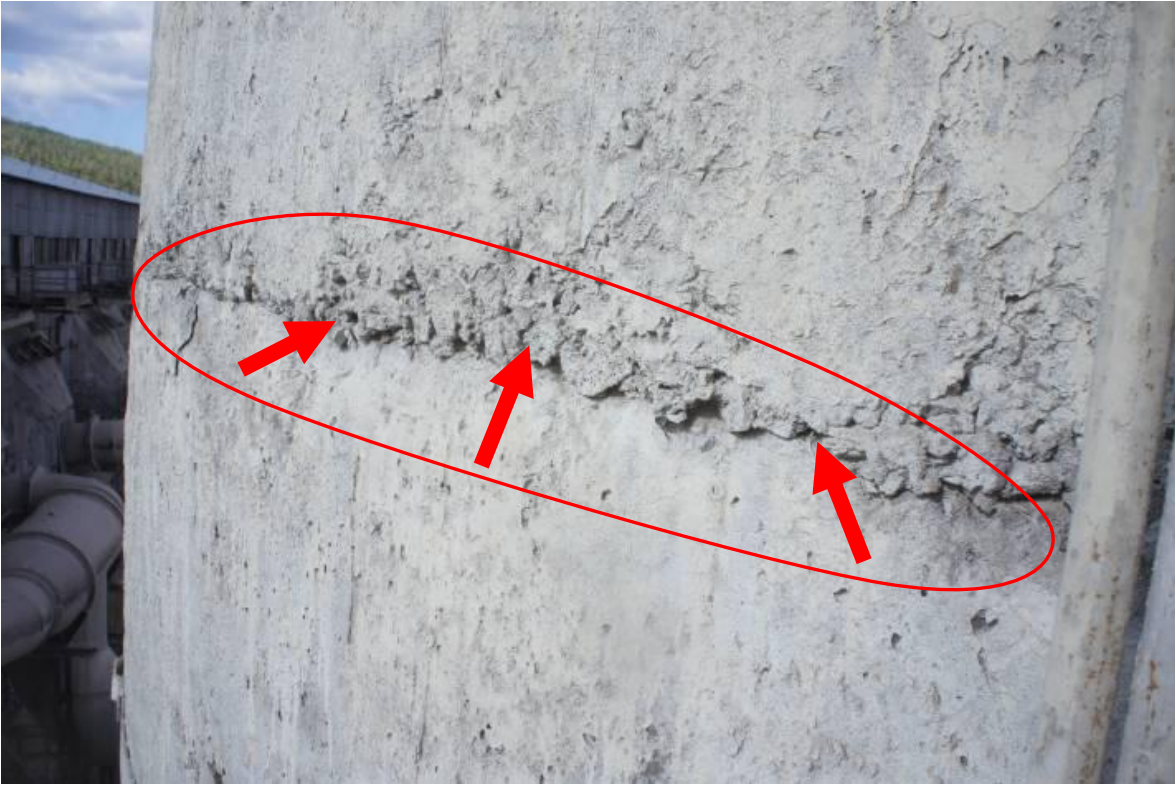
Цилиндрический железобетонный газоотводящий ствол
